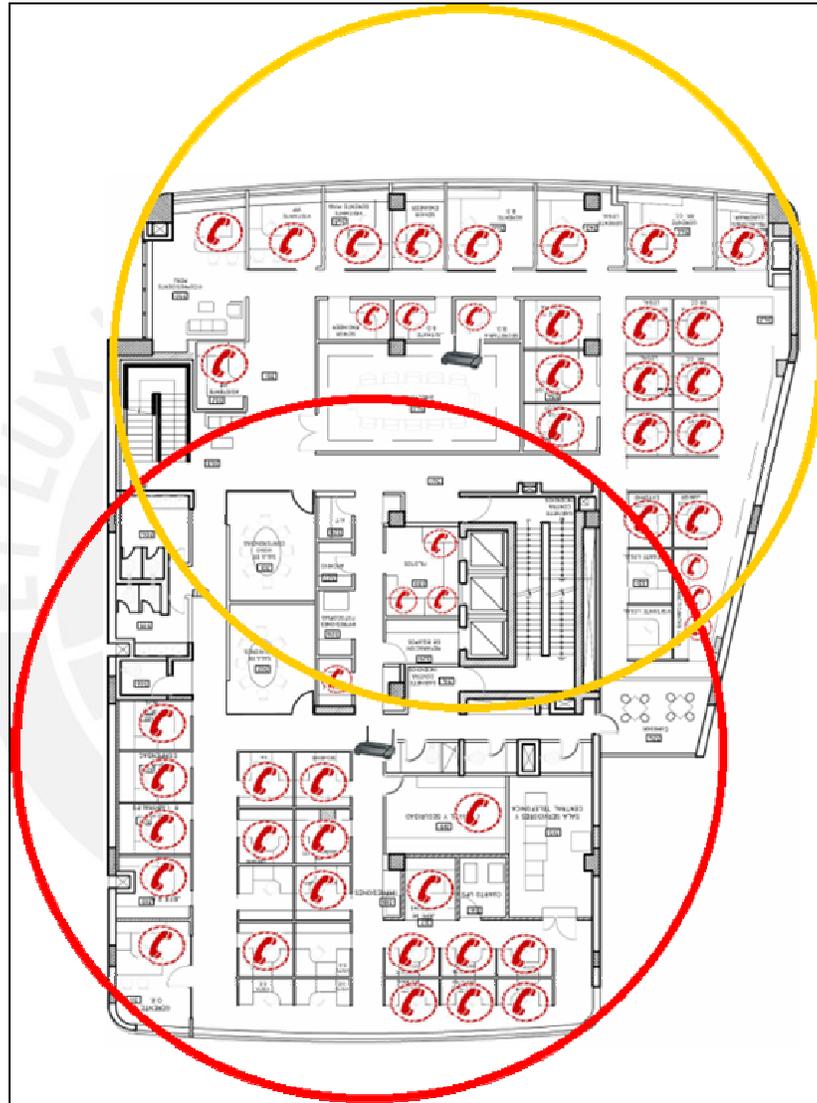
PLANO DE COBERTURA – SEGUNDA PLANTA
